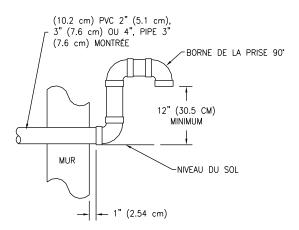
Installation d'un système de ventilation forcée vertical typique
